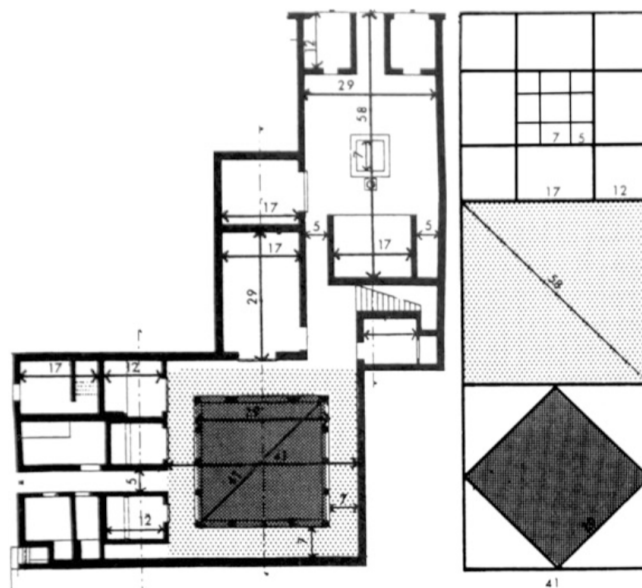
análises de proporções em planta da Casa da Coluna Toscana
